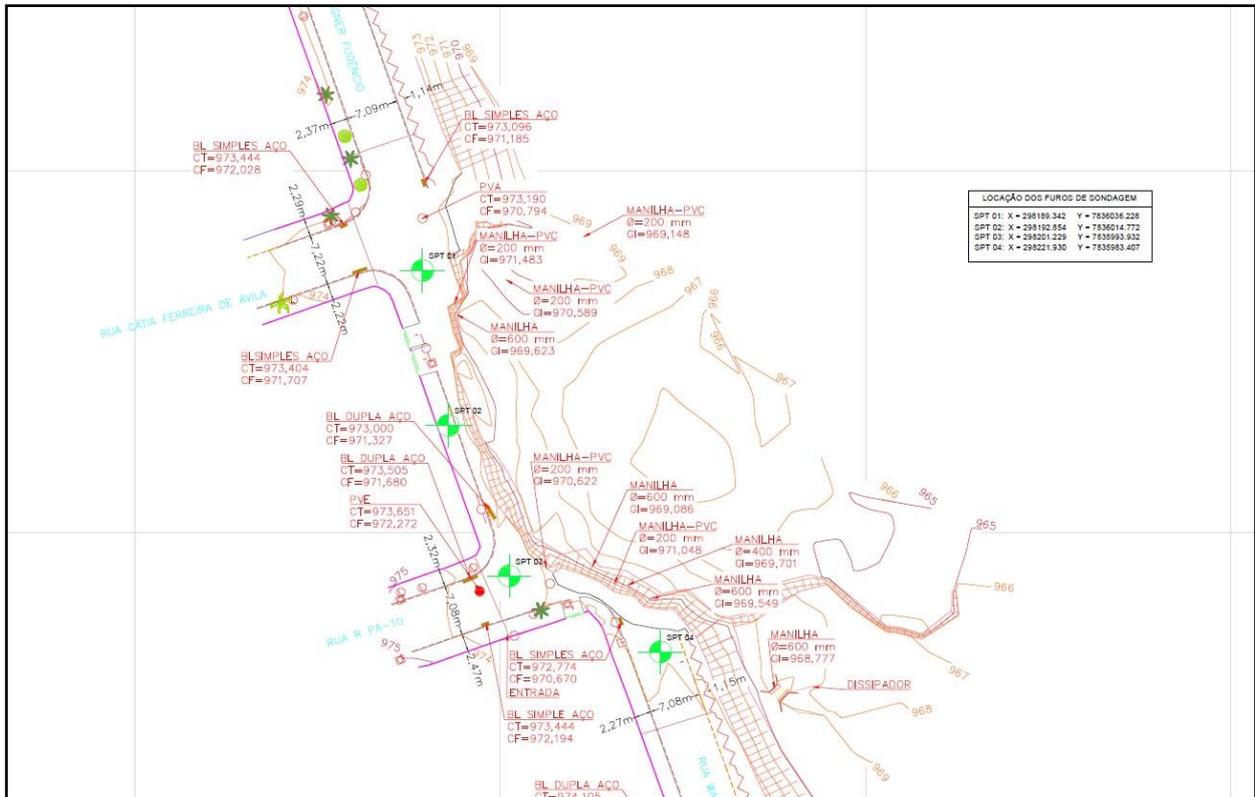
Planta topográfica e indicação dos furos de sondagem, destacados em verde.
